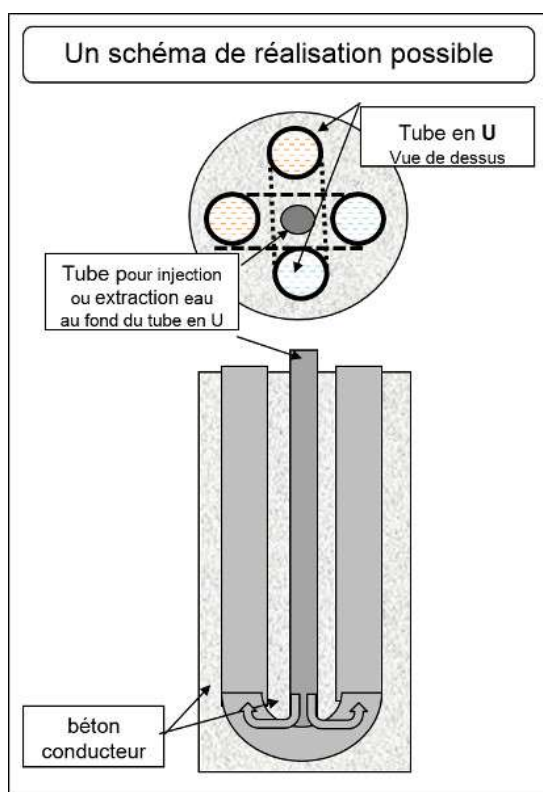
Coupe horizontale d'un puits et coupe verticale selon un diamètre.
